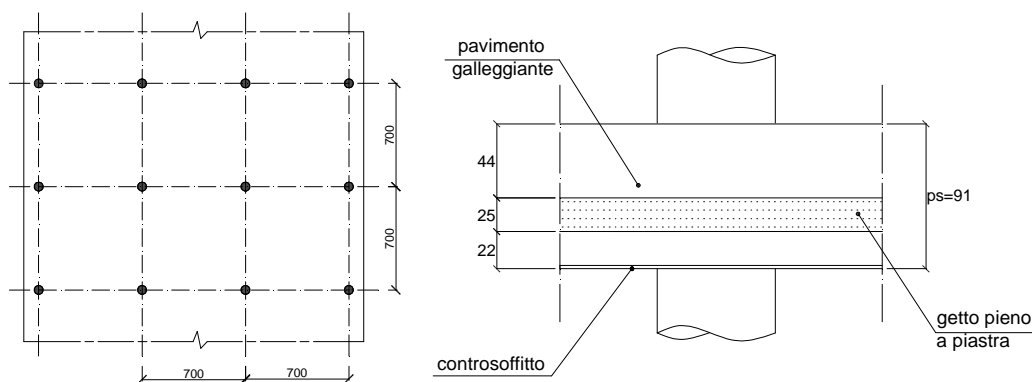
soluzione n.°1 in NSC, pianta di piano e sezione impalcato
